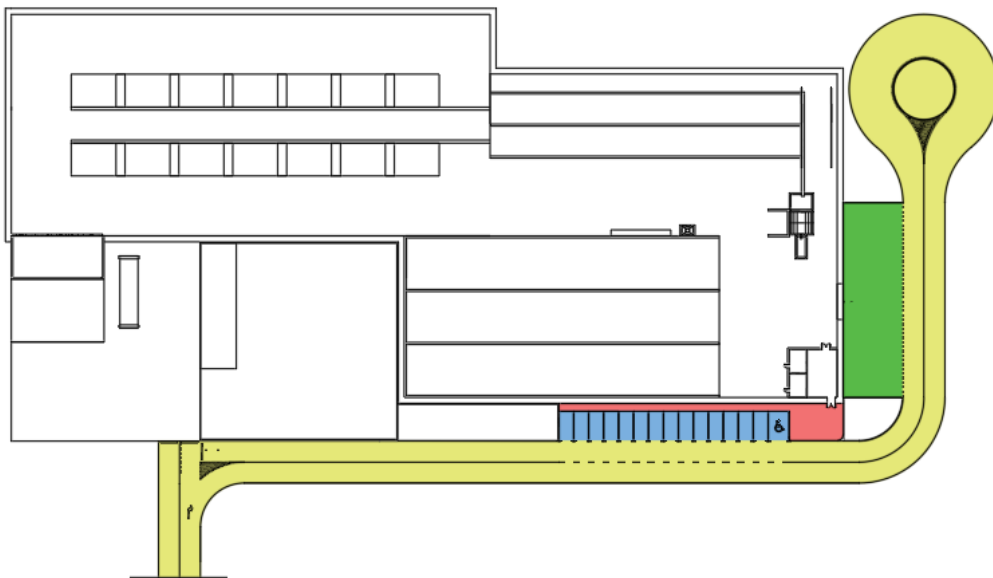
Disposición de la planta, Opción 1. Fuente: Elaboración propia
